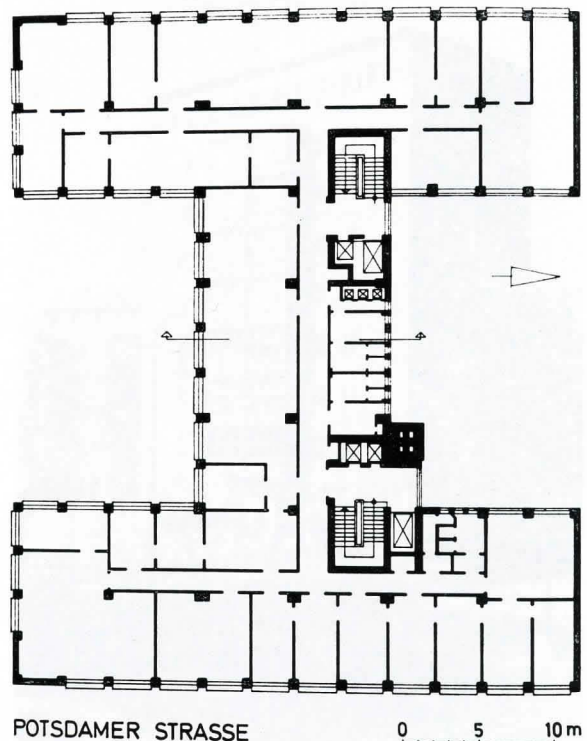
Kathreiner-Hochhaus, Grundriß eines Normalgeschosses.
